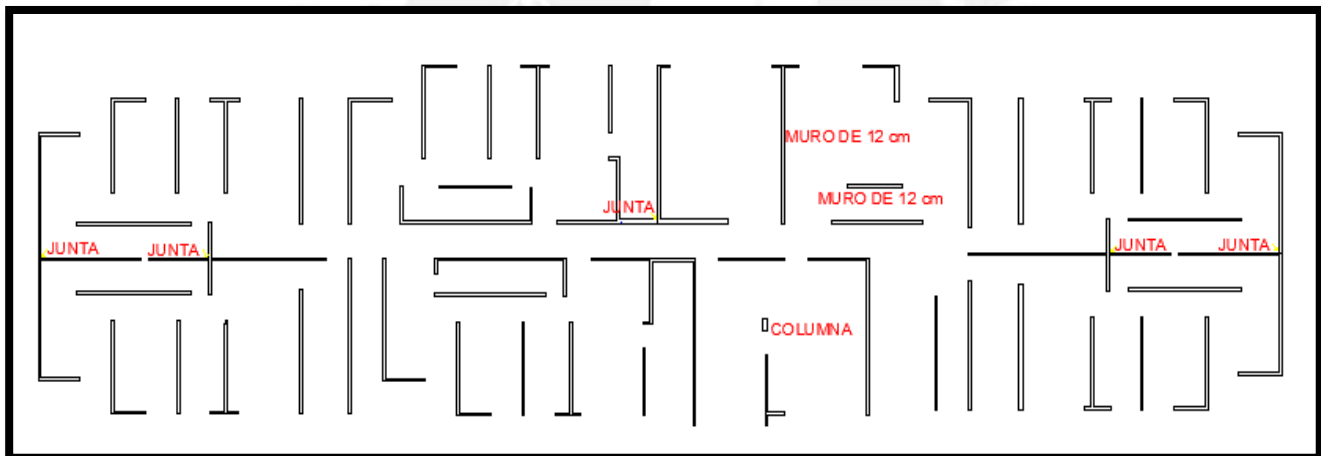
PLANTA DE MUROS ESTRUCTURALES.
